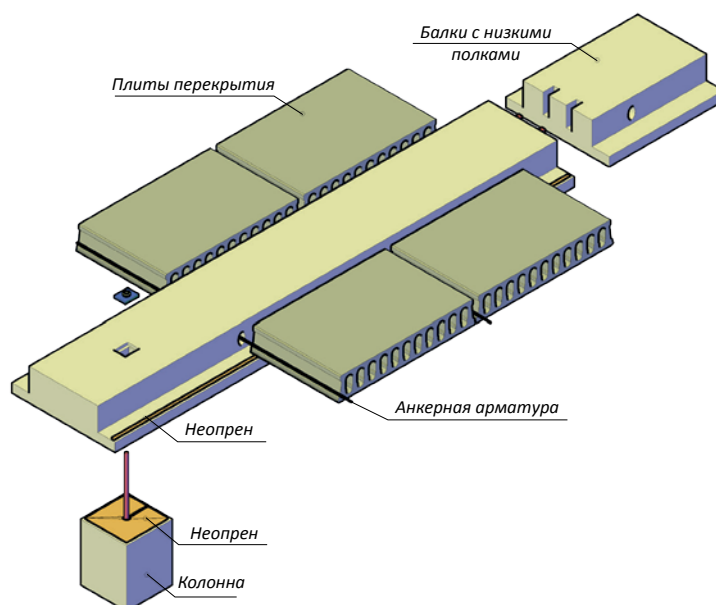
Общая схема соединения конструктивных элементов перекрытия.
